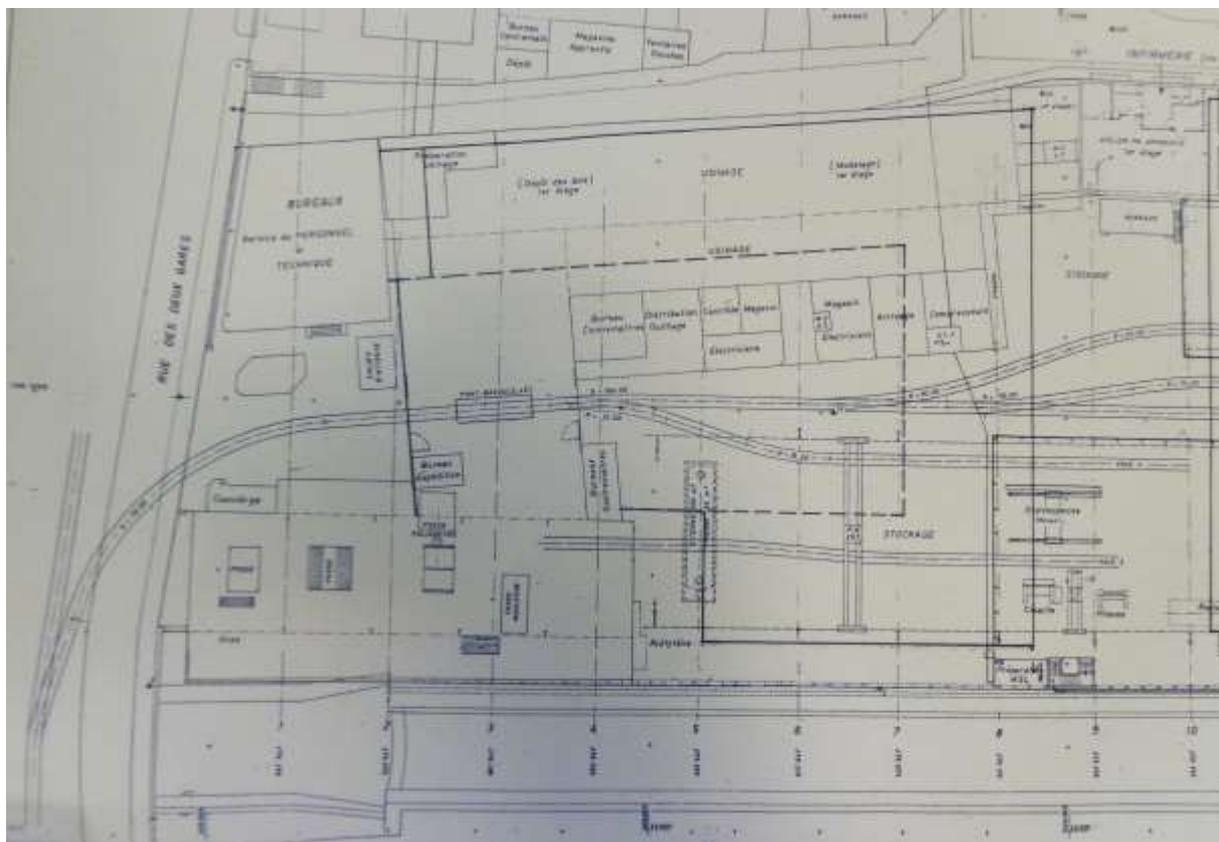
Plan général du site des ACMV au 1<sup>er</sup> janvier 1975 avec niveau des halles & voies (détail halle Inox avec fosses) (AVV, 96.01, Fonds ACMV).
